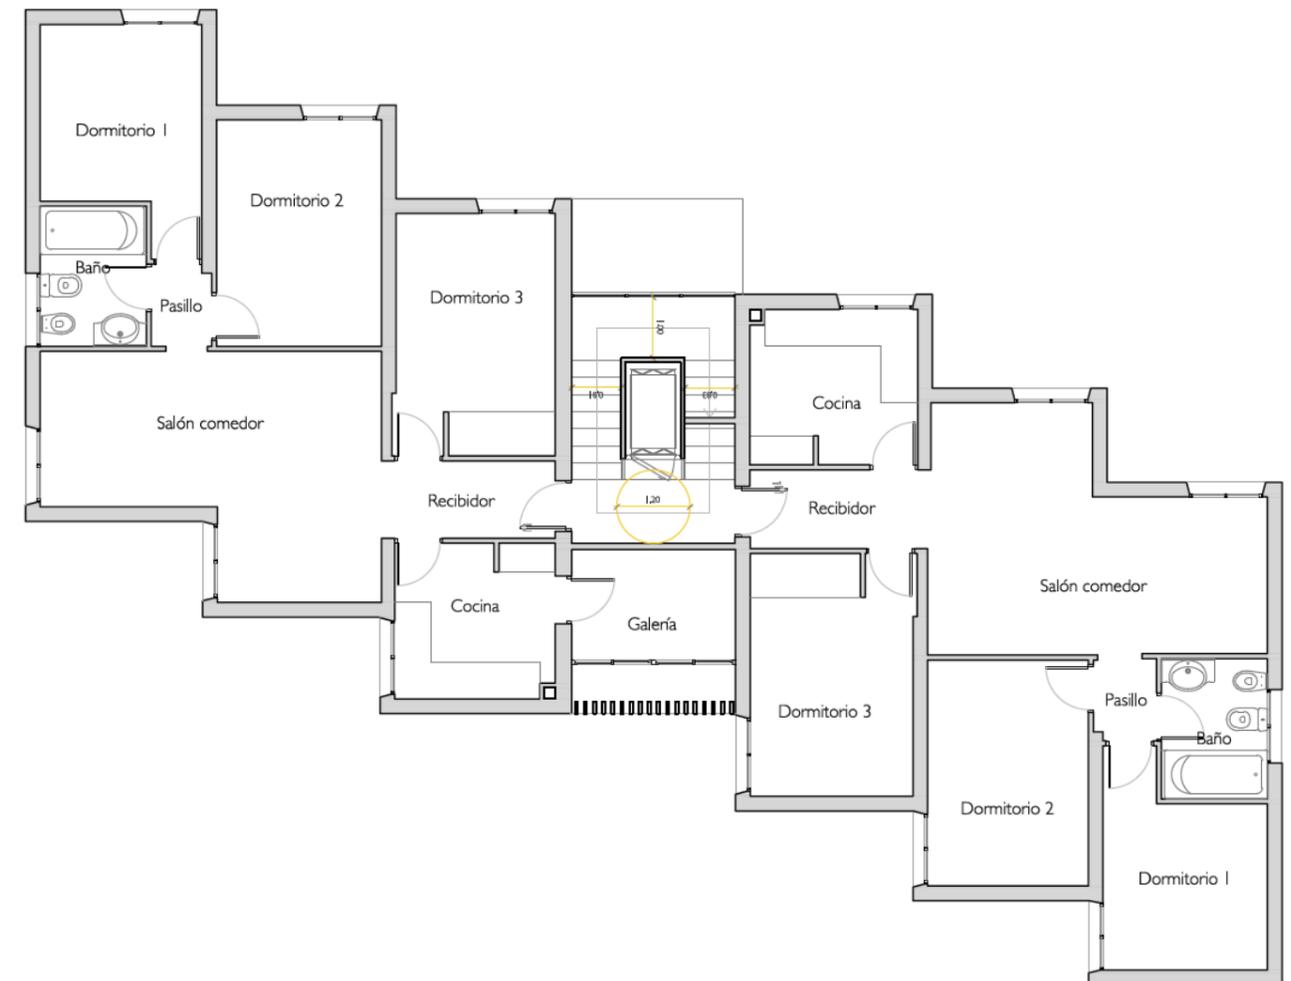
Plano zaguán. Planta tipo. OPCIÓN 2
